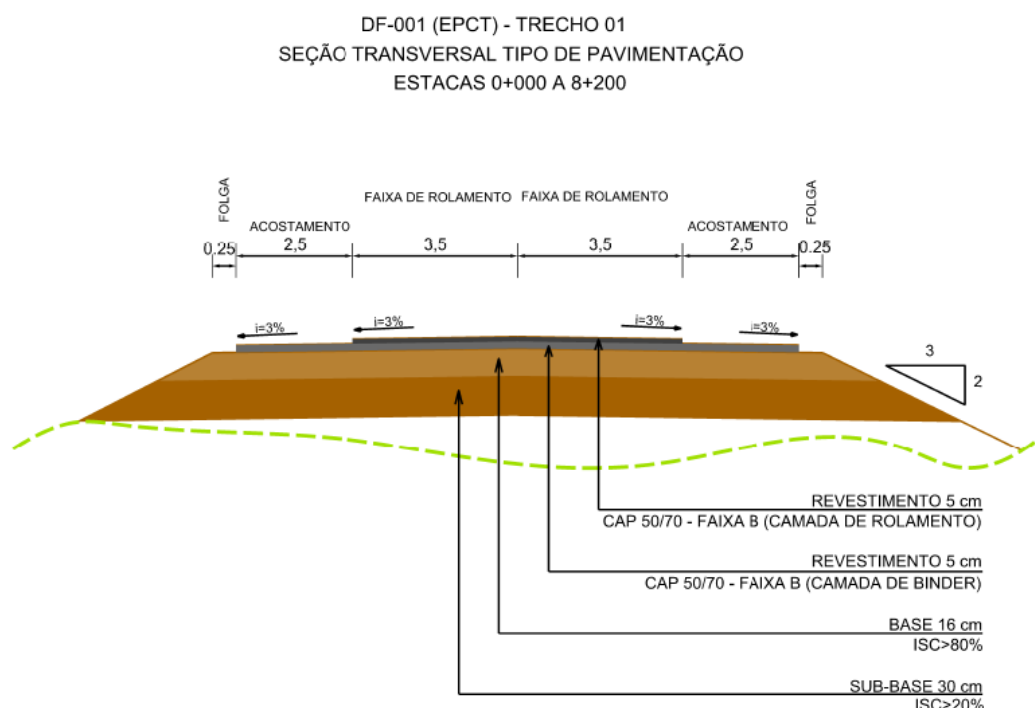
Seção Transversal Tipo da Pavimentação da DF-001
